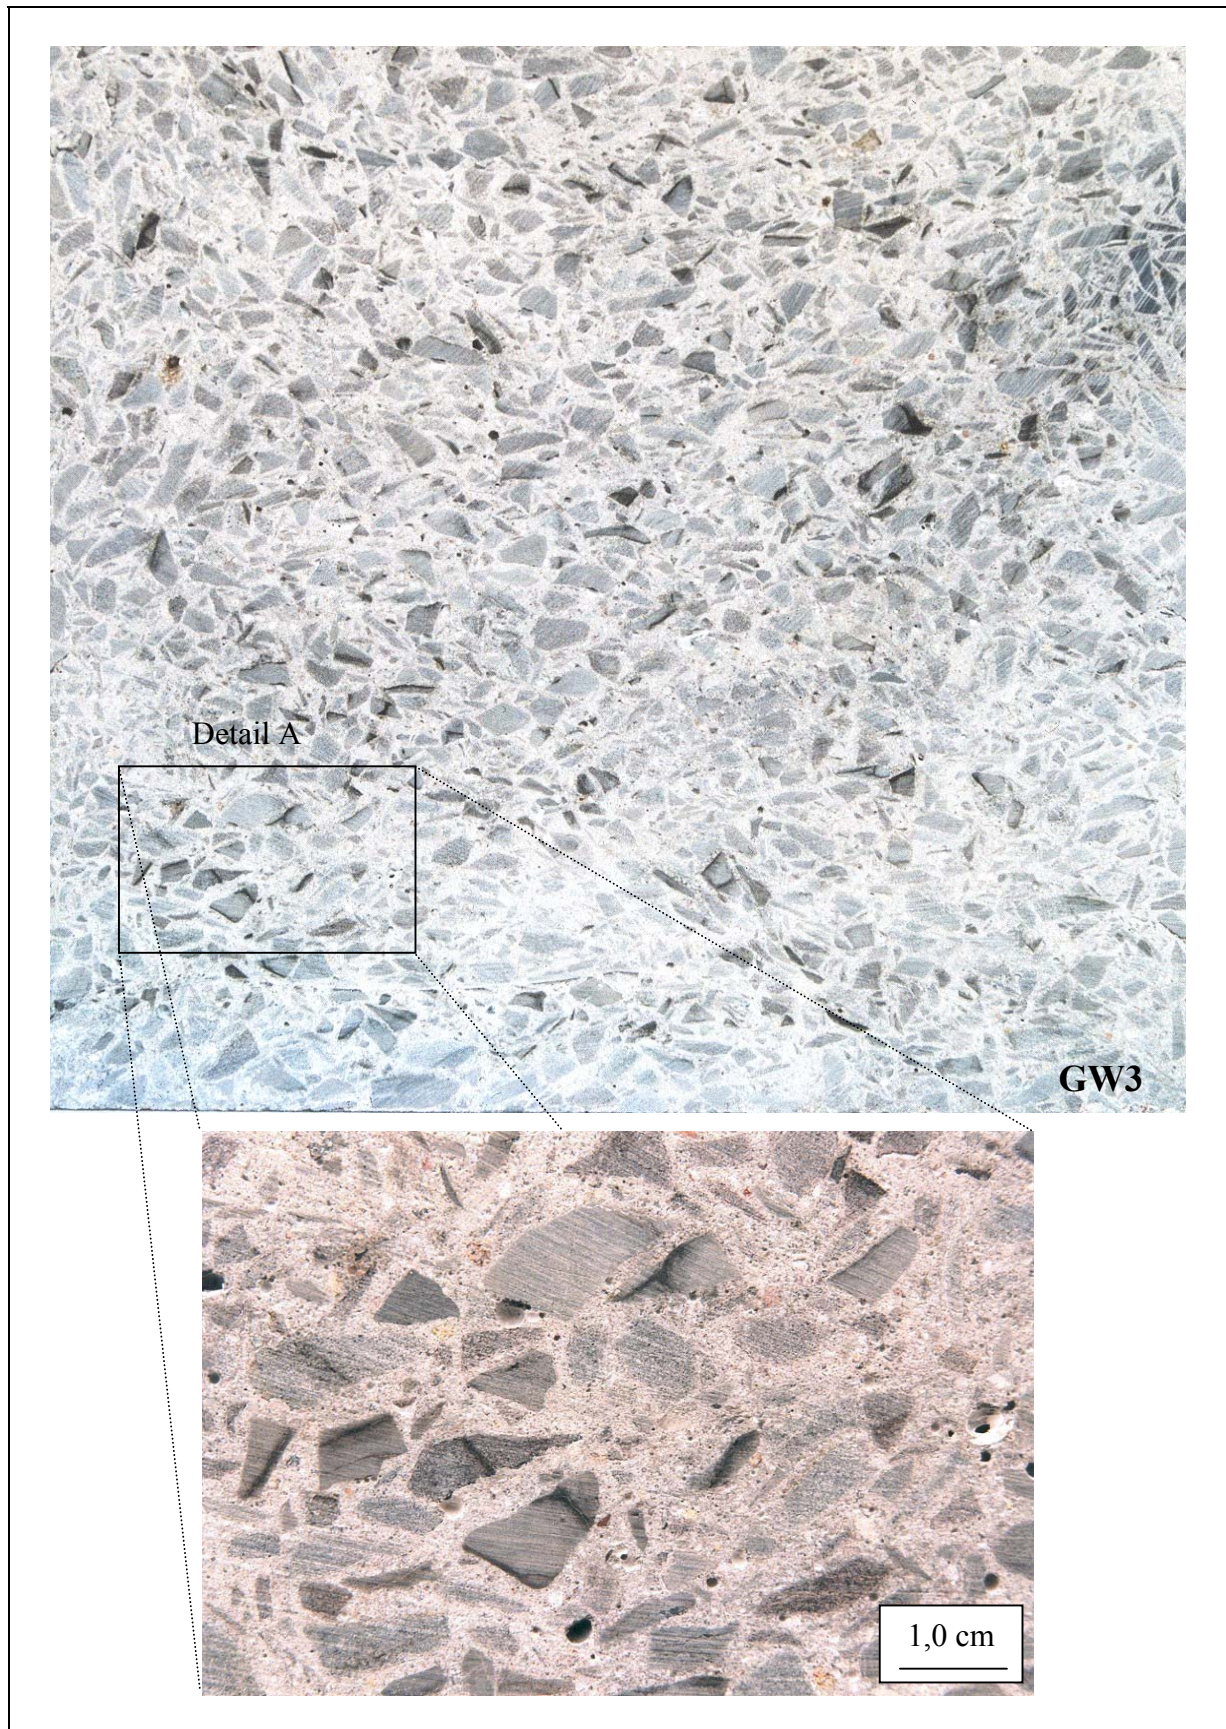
Querschnitt des Betonwürfels mit GW3 (oben) und Detail A (unten) nach neunmonatiger Nebelkammerlagerung (Kantenlänge Würfel 30 cm)
